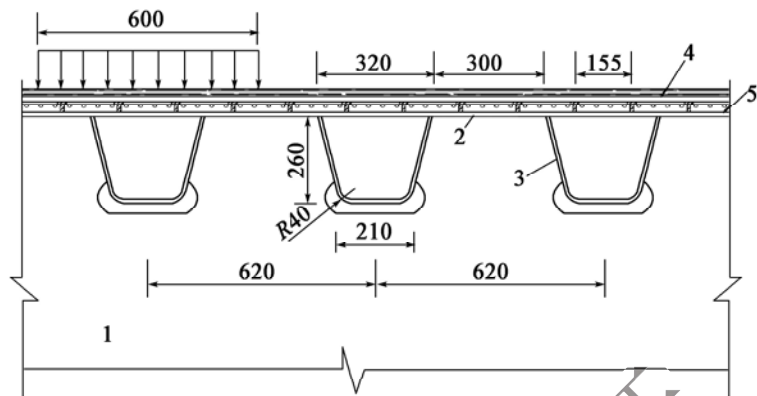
计算模型示意（尺寸单位：mm）
